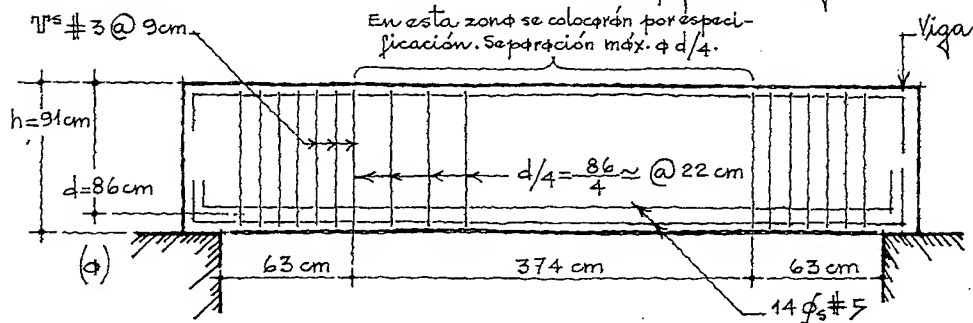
Zonas de la viga donde se requieren estribos por cálculo (b).
